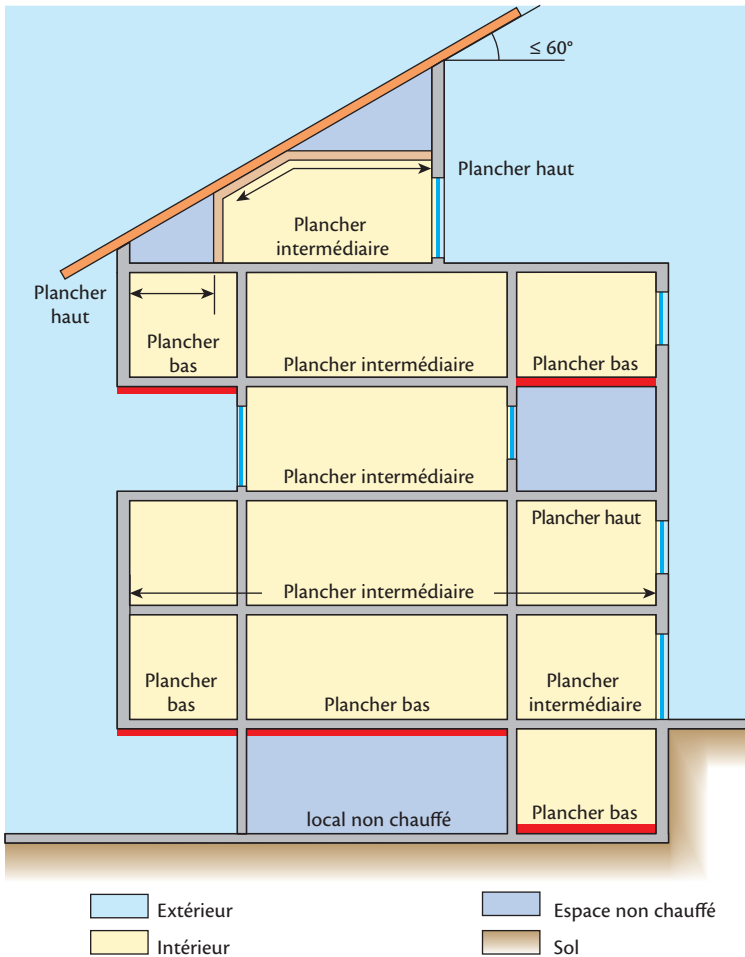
Définition d'un plancher bas au sens de la réglementation thermique
